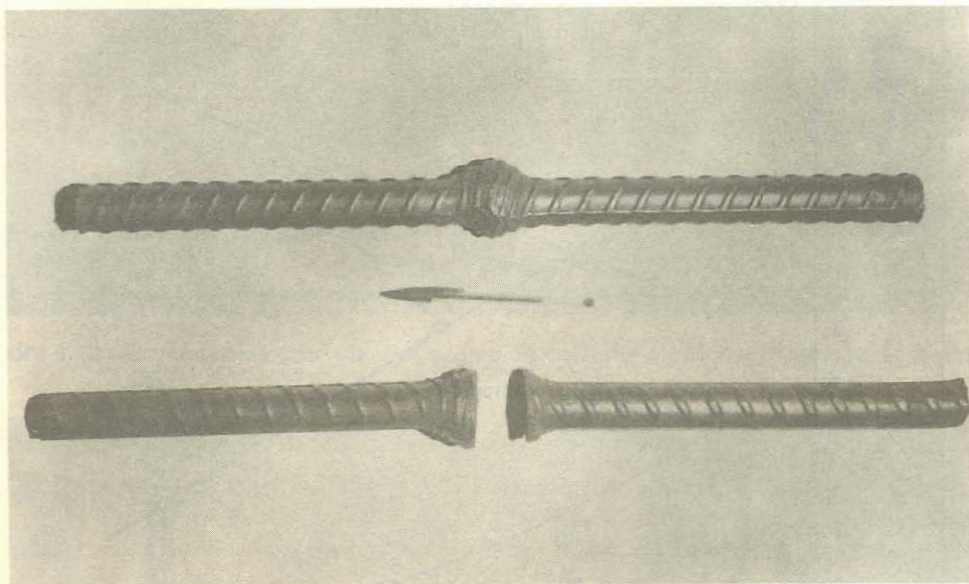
Solda de topo por caldeamento, obtidas com máquina manual
